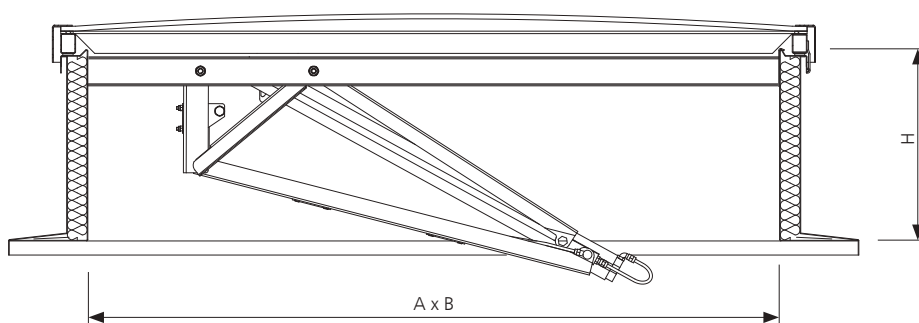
Posadowienie kłap na dachu systemowym typu SANDWICH
